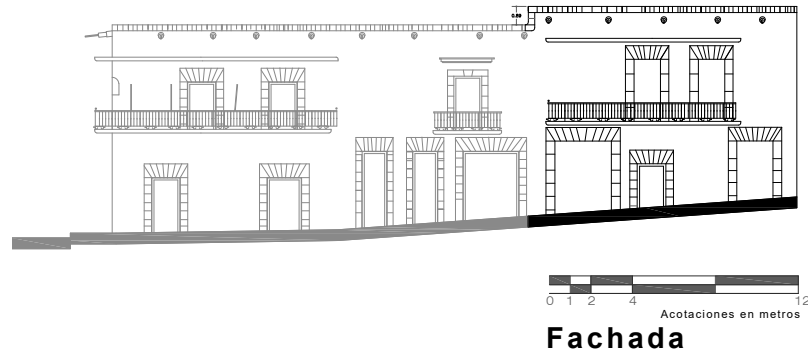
Fachada principal de la CAMEM incluyendo su integración con el Museo del Estado de Michoacán. Fuente: Planos elaborados por METR septiembre 2020.
